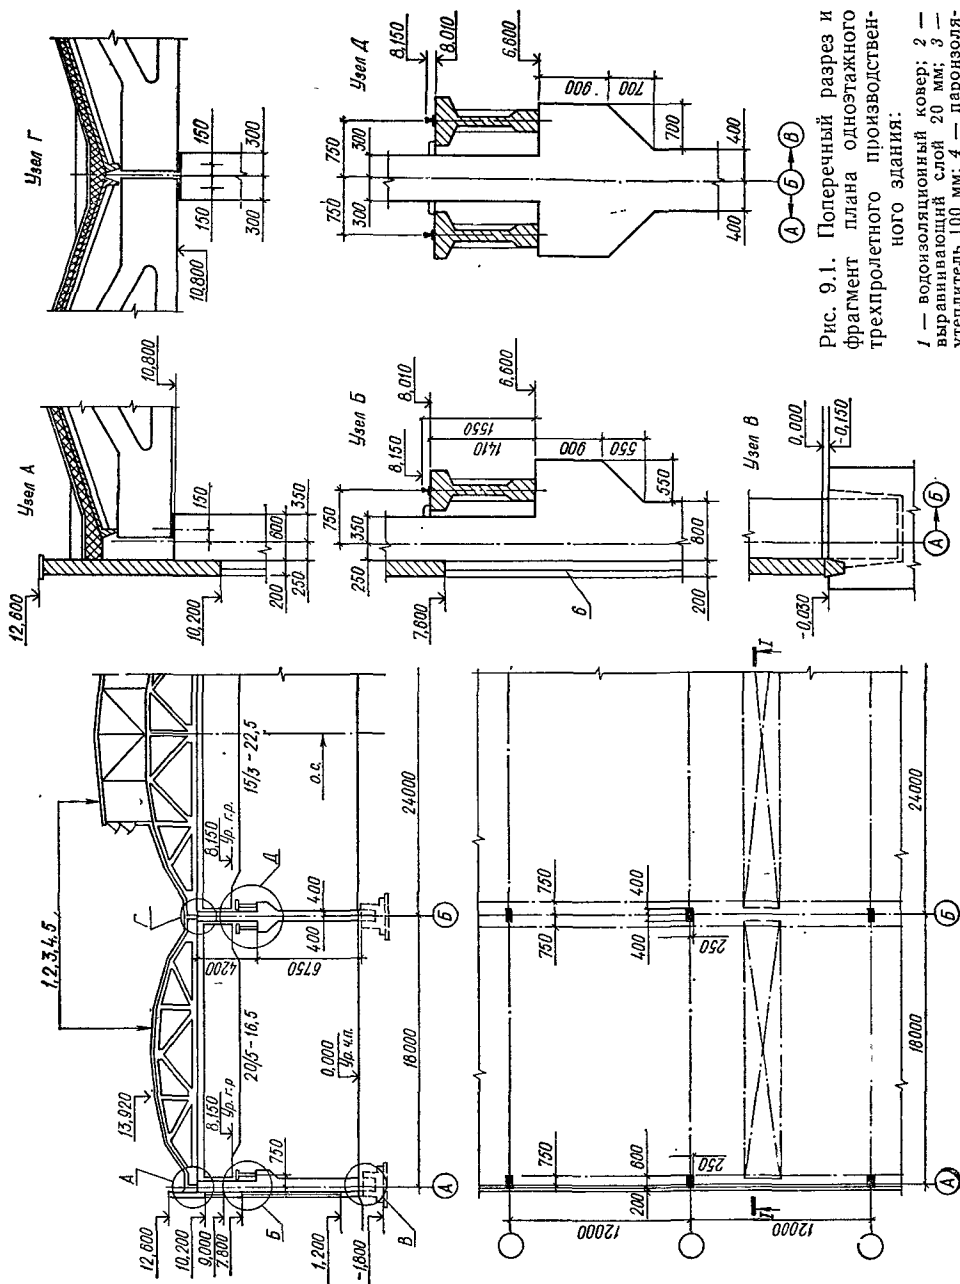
Поперечный разрез и фрагмент плана одноэтажного трехэтажного производственного здания:
